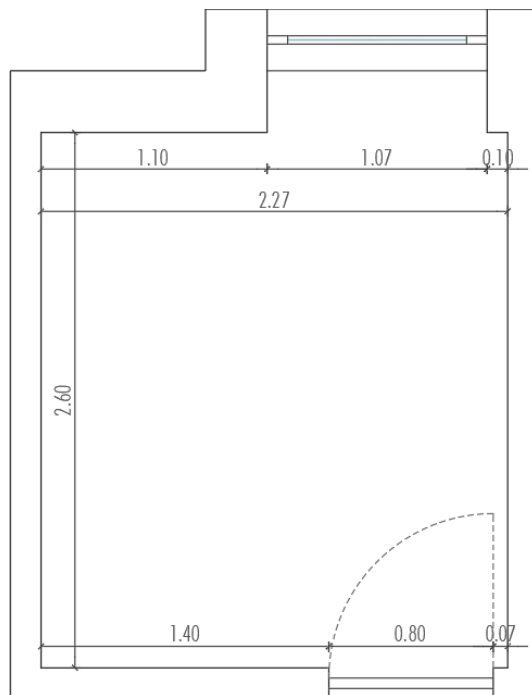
Planta existente do espaço a desenvolver (Fonte: Autora, 2022)
